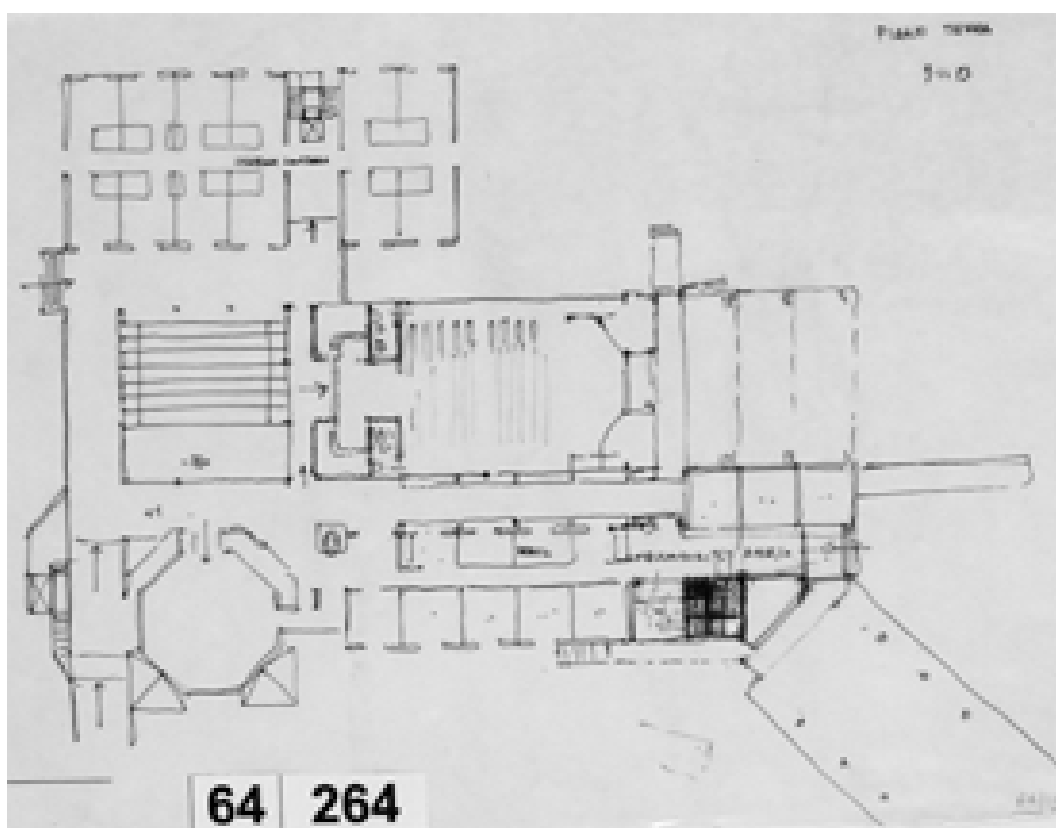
Pianta piano terra, stato futuro – 09/11/1993 (AABS-64_264)
